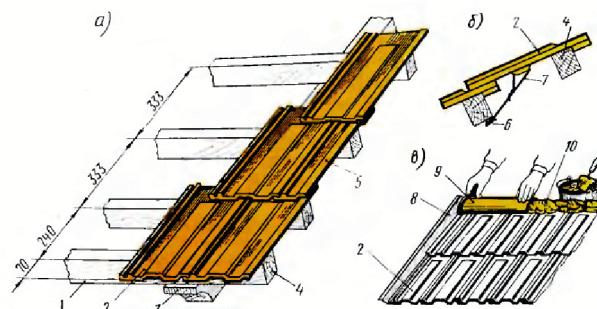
Покрытие кровли пазовой ленточной черепицей:
